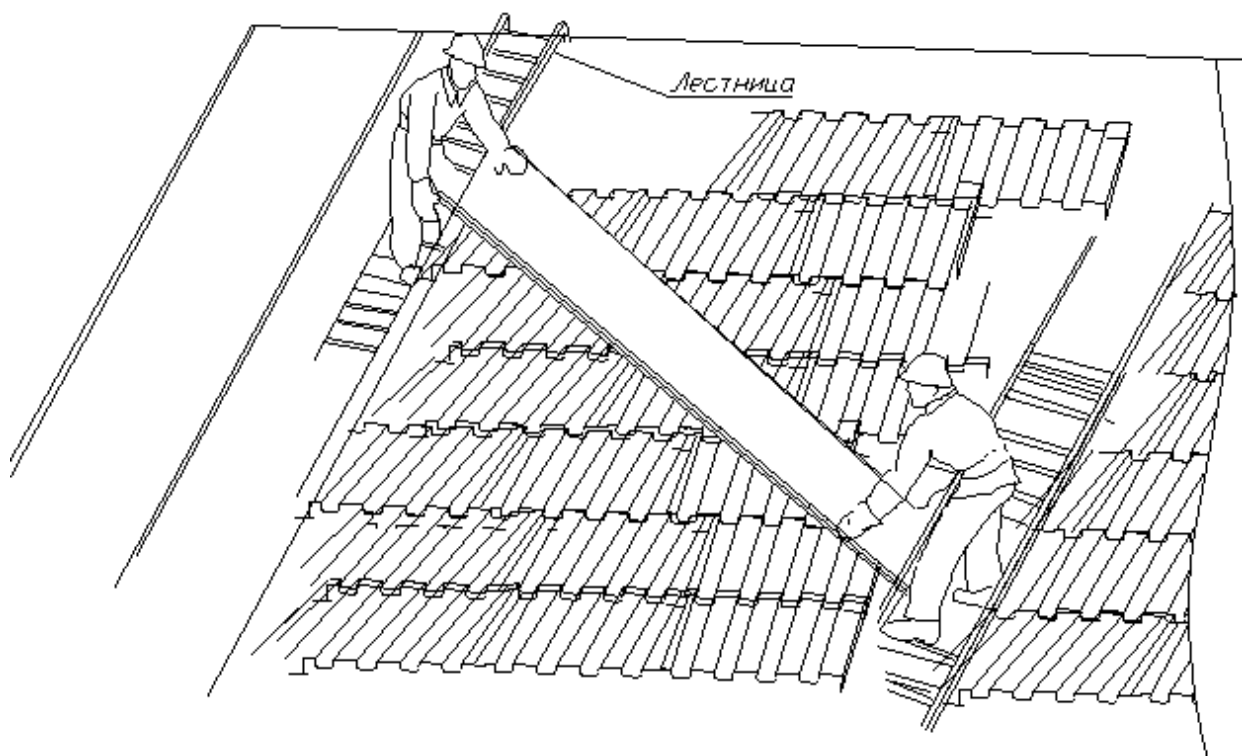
Поднятие кровельных листов на крышу и установка от конька до ската кровли
